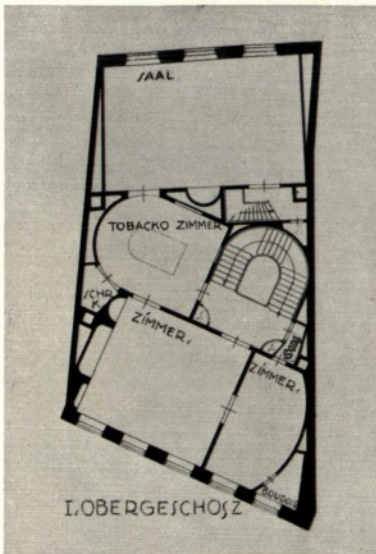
und 23. Lillie: Lübeck, Breite Straße 50 und 48, Hauptgeschoß-Grundrisse
